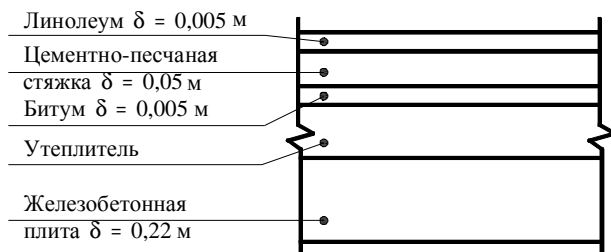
Конструкция перекрытия над неотапливаемым подвалом
